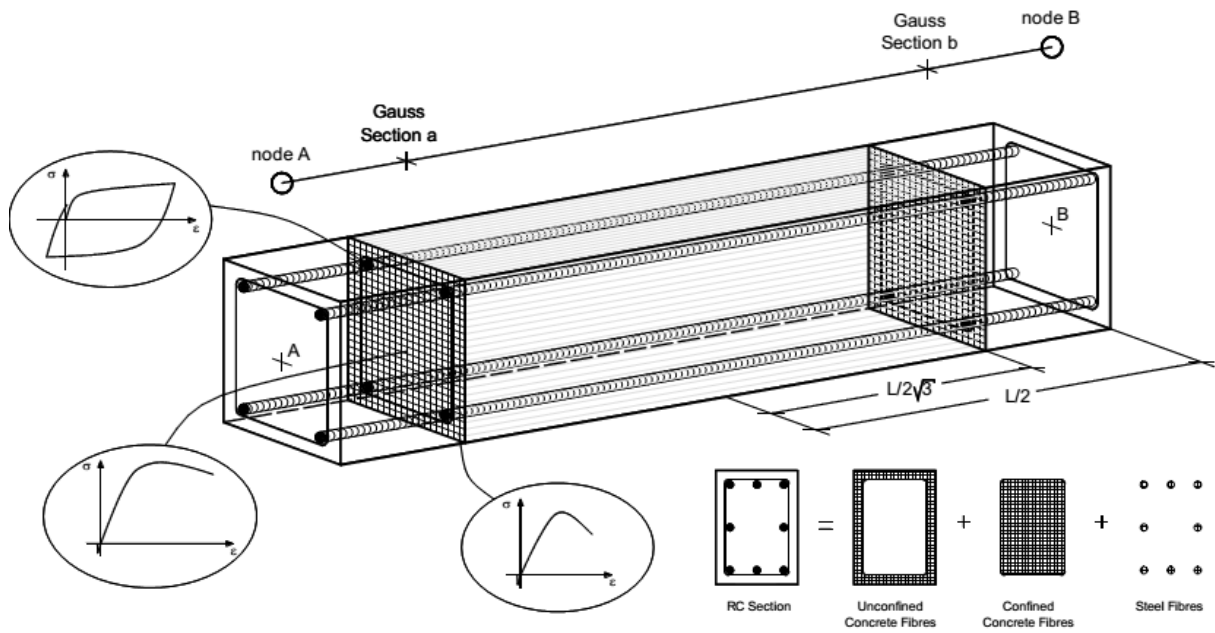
Discretisation en fibres de la section transversale typique du béton armé [88]
